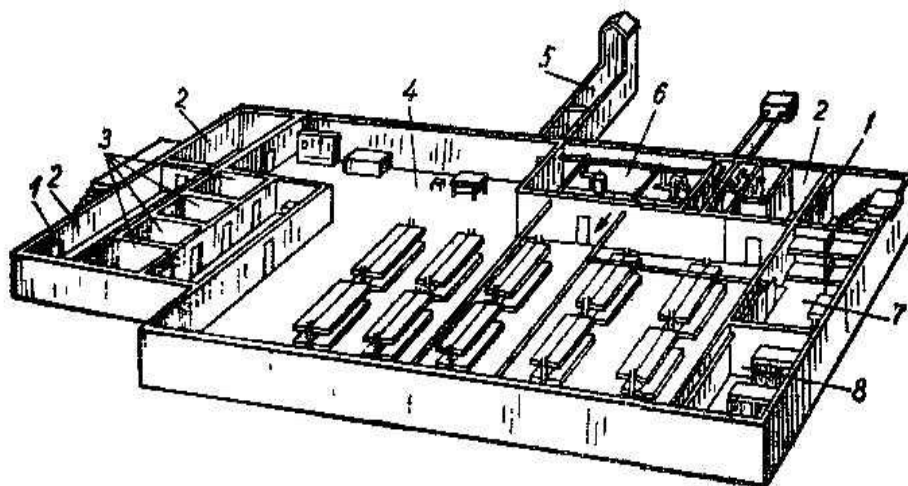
План убежища: 1 – защитно-герметические двери; 2 – шлюзовые камеры (тамбуры); 3 – санитарно-бытовые отсеки; 4 – основное помещение для размещения людей; 5 – галерея и оголовок аварийного выхода; 6 – фильтровентиляционная камера; 7 – кладовая для продуктов питания; 8 – медицинская комната (помещения 7 и 8 могут не устраиваться).
